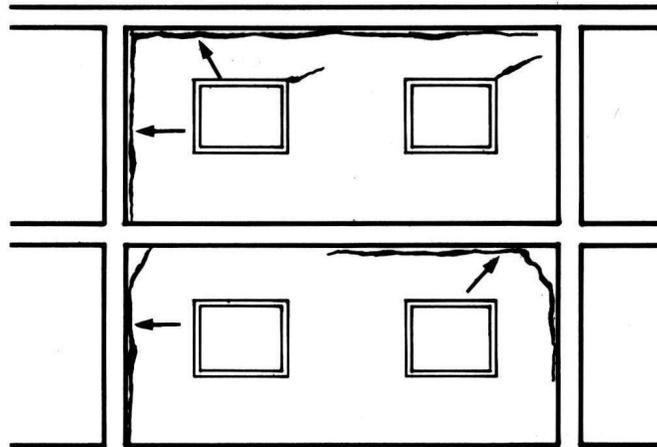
Fissura no encontro dos componentes de vedação.
